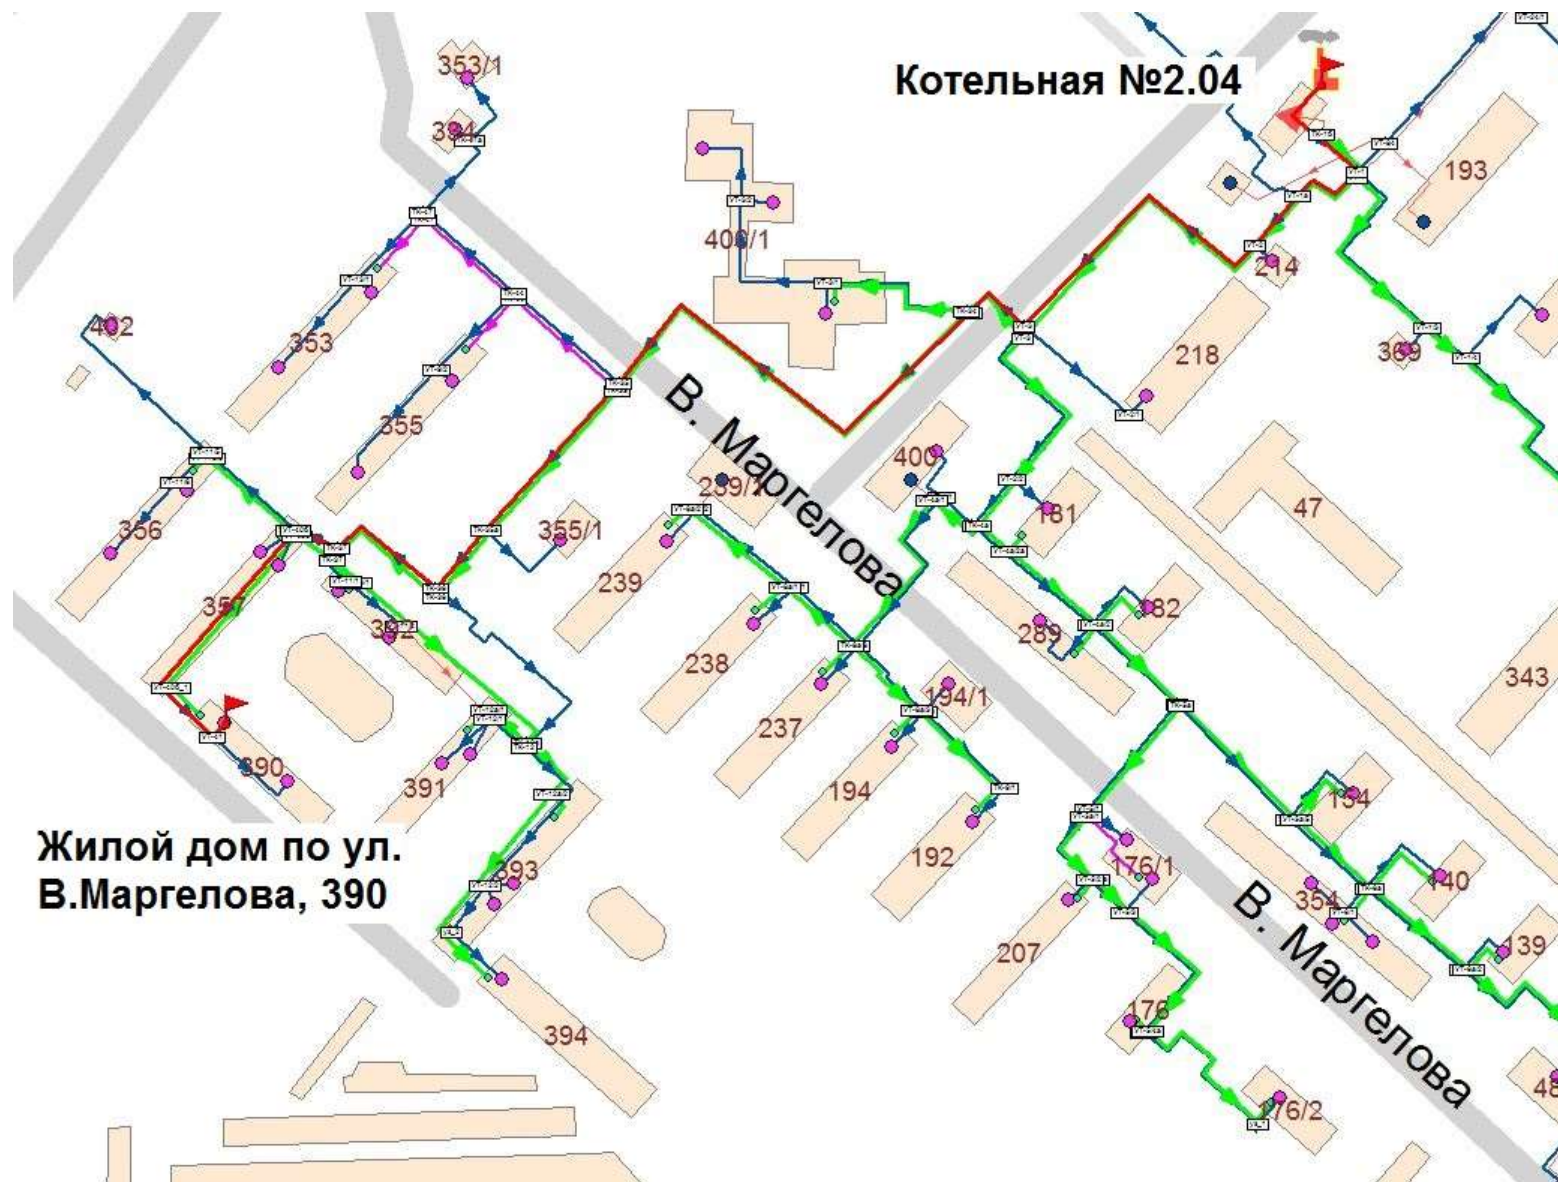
Трассировка теплопровода от Котельной 2.04 до жилого дома по ул. В. Маргелова, 390
